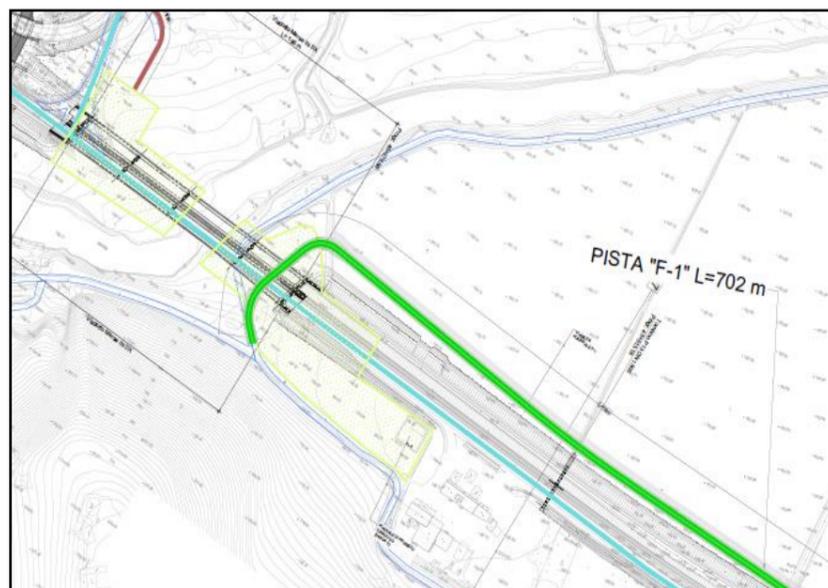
Cantieri e piste a servizio della realizzazione del Viadotto Merse
